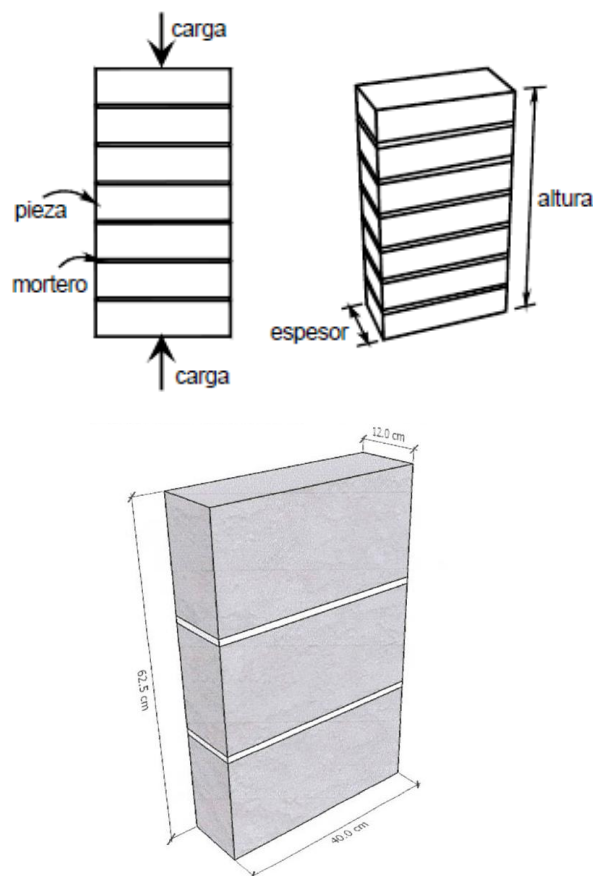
Pilas de Mampostería para la prueba de Resistencia a la Compresión (la pila con dimensiones pertenece a una prueba realizada a unas piezas multiperforadas de Blocks de Concreto BH8 IBMEX).^{3,8}
